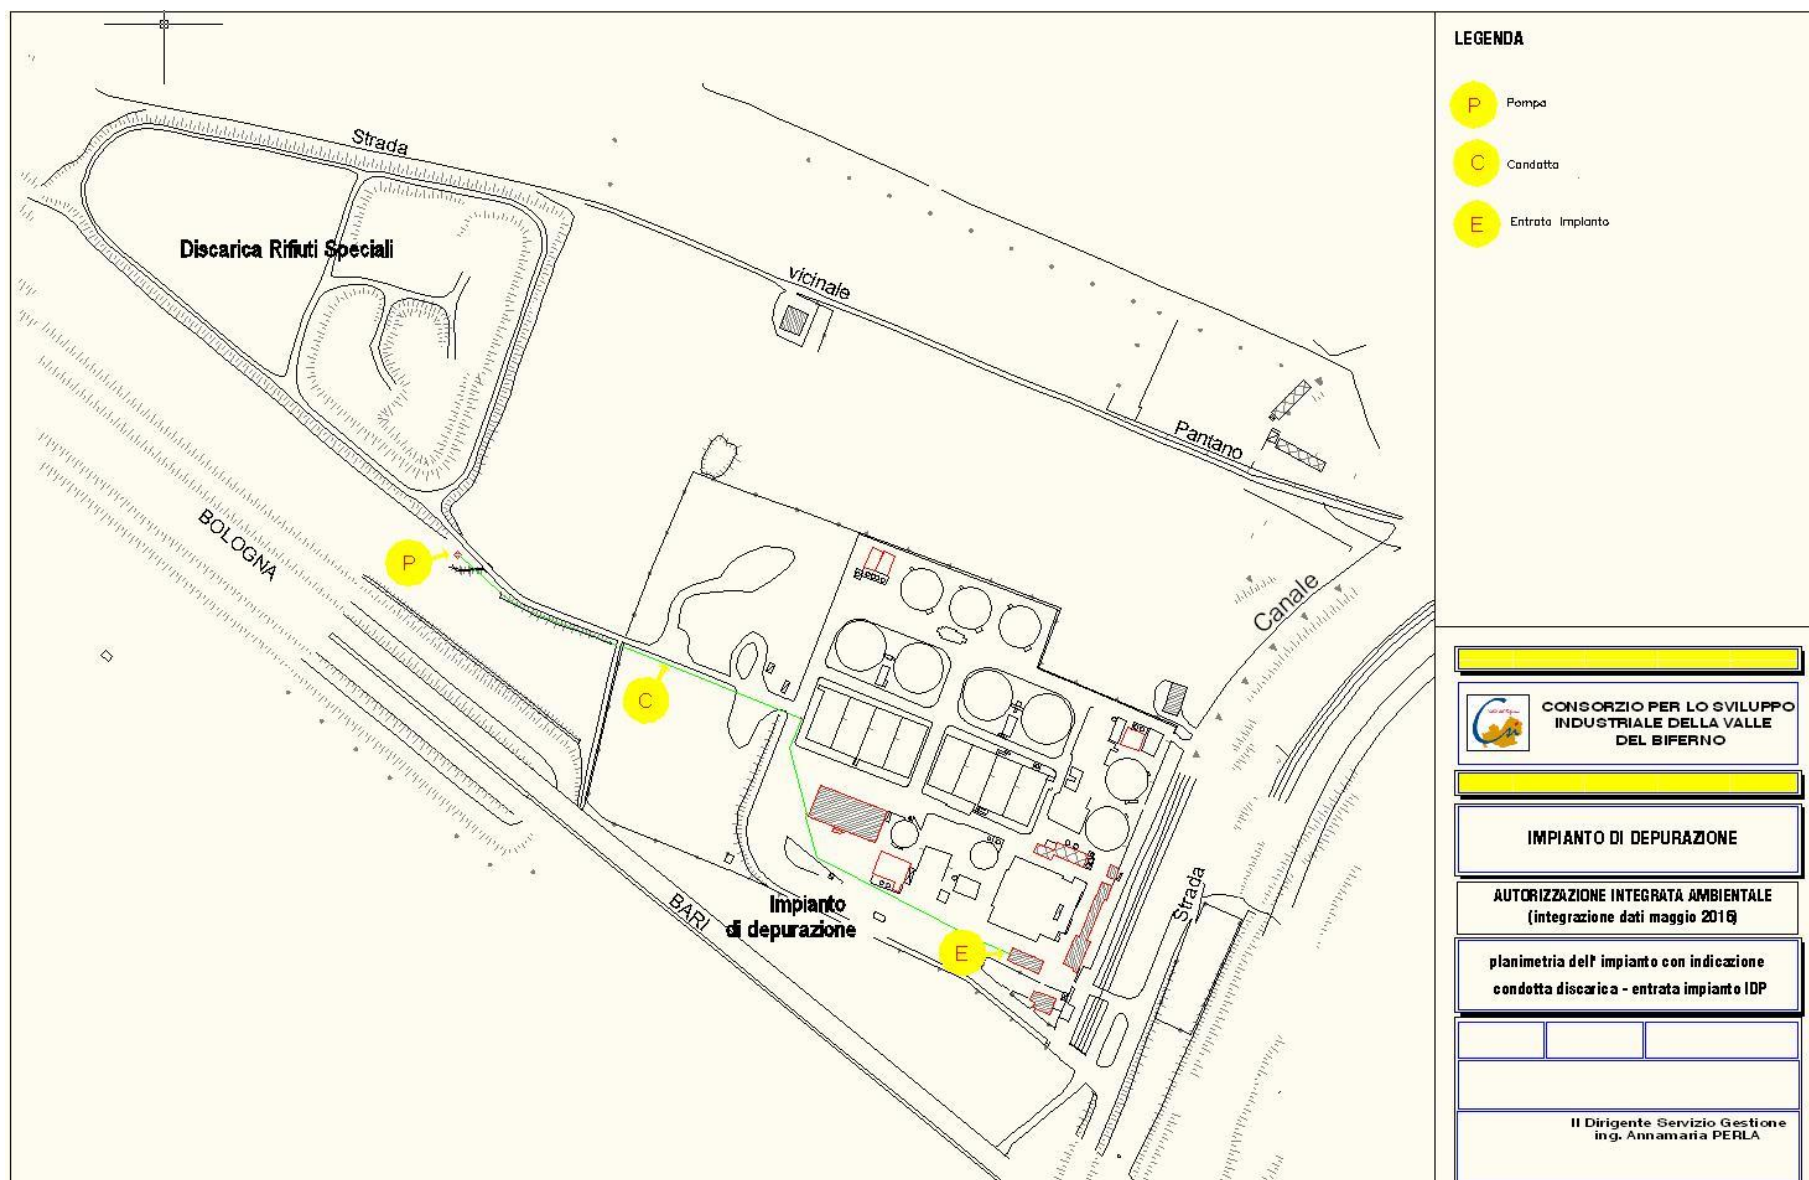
planimetria generale dell'impianto: schema di trattamento del refluo percolato della discarica consortile del C.S.I. Valle del Biferno
